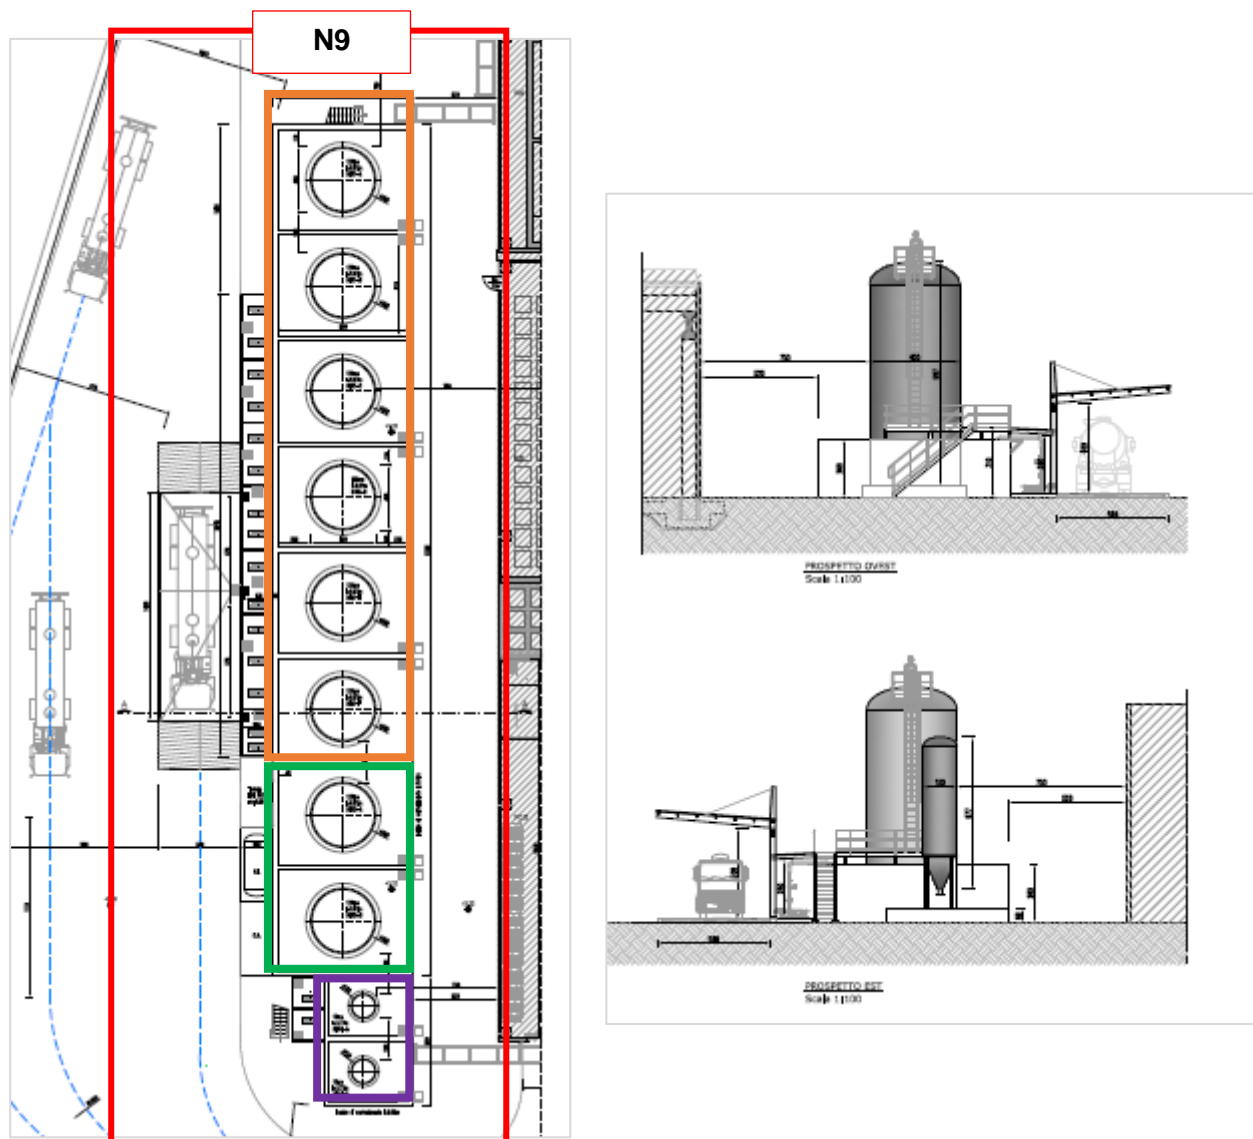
Dettaglio localizzazione Sezione N9 (dx) e prospetti est/ovest (sx) (Stralci elaborati CO 05 RA VA 00 D1 PL 54.00 - N9 PIANTE e CO 05 RA VA 00 D1 PL 55.00 - N9 PROSPETTI E SEZIONI)
